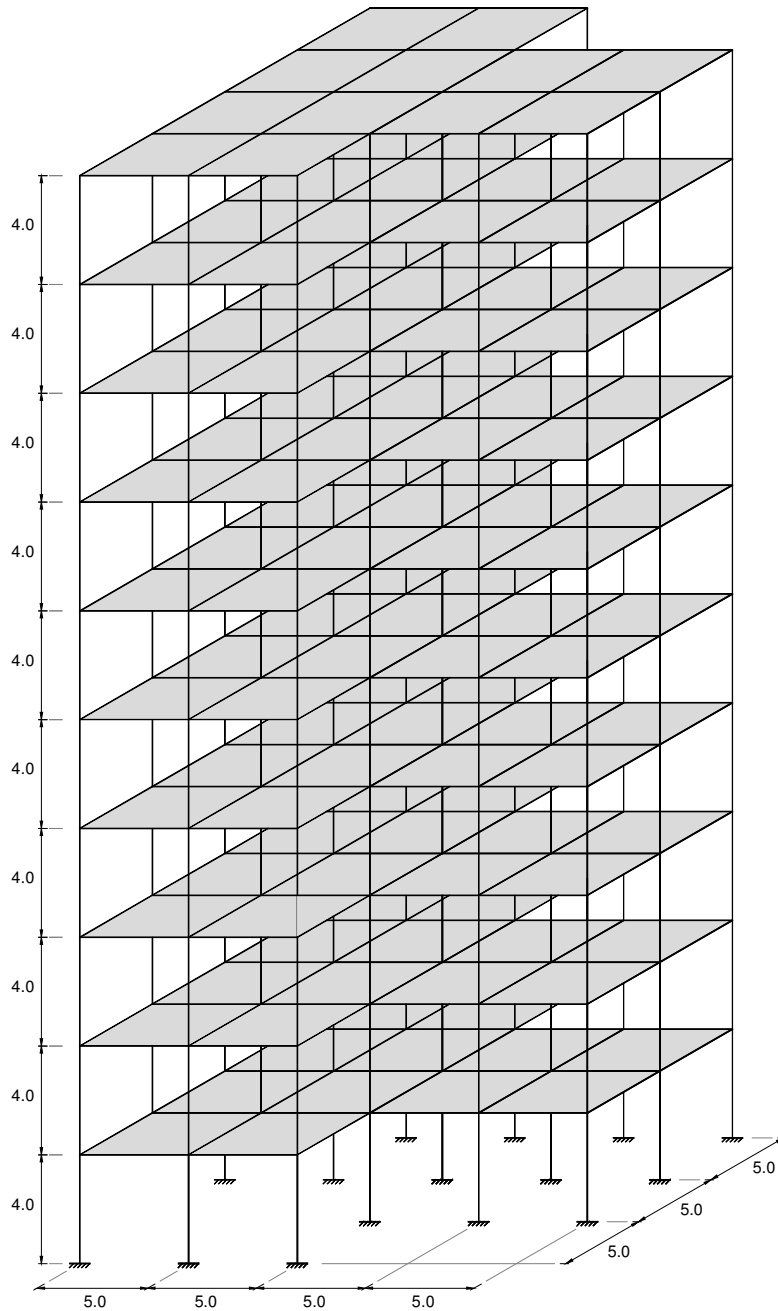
Perspectiva do pórtico com 10 pisos e assimetria em planta.
